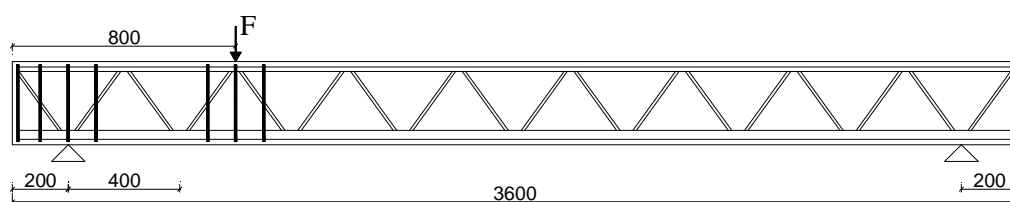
Schema di carico e sezione longitudinale travi sperimentate
